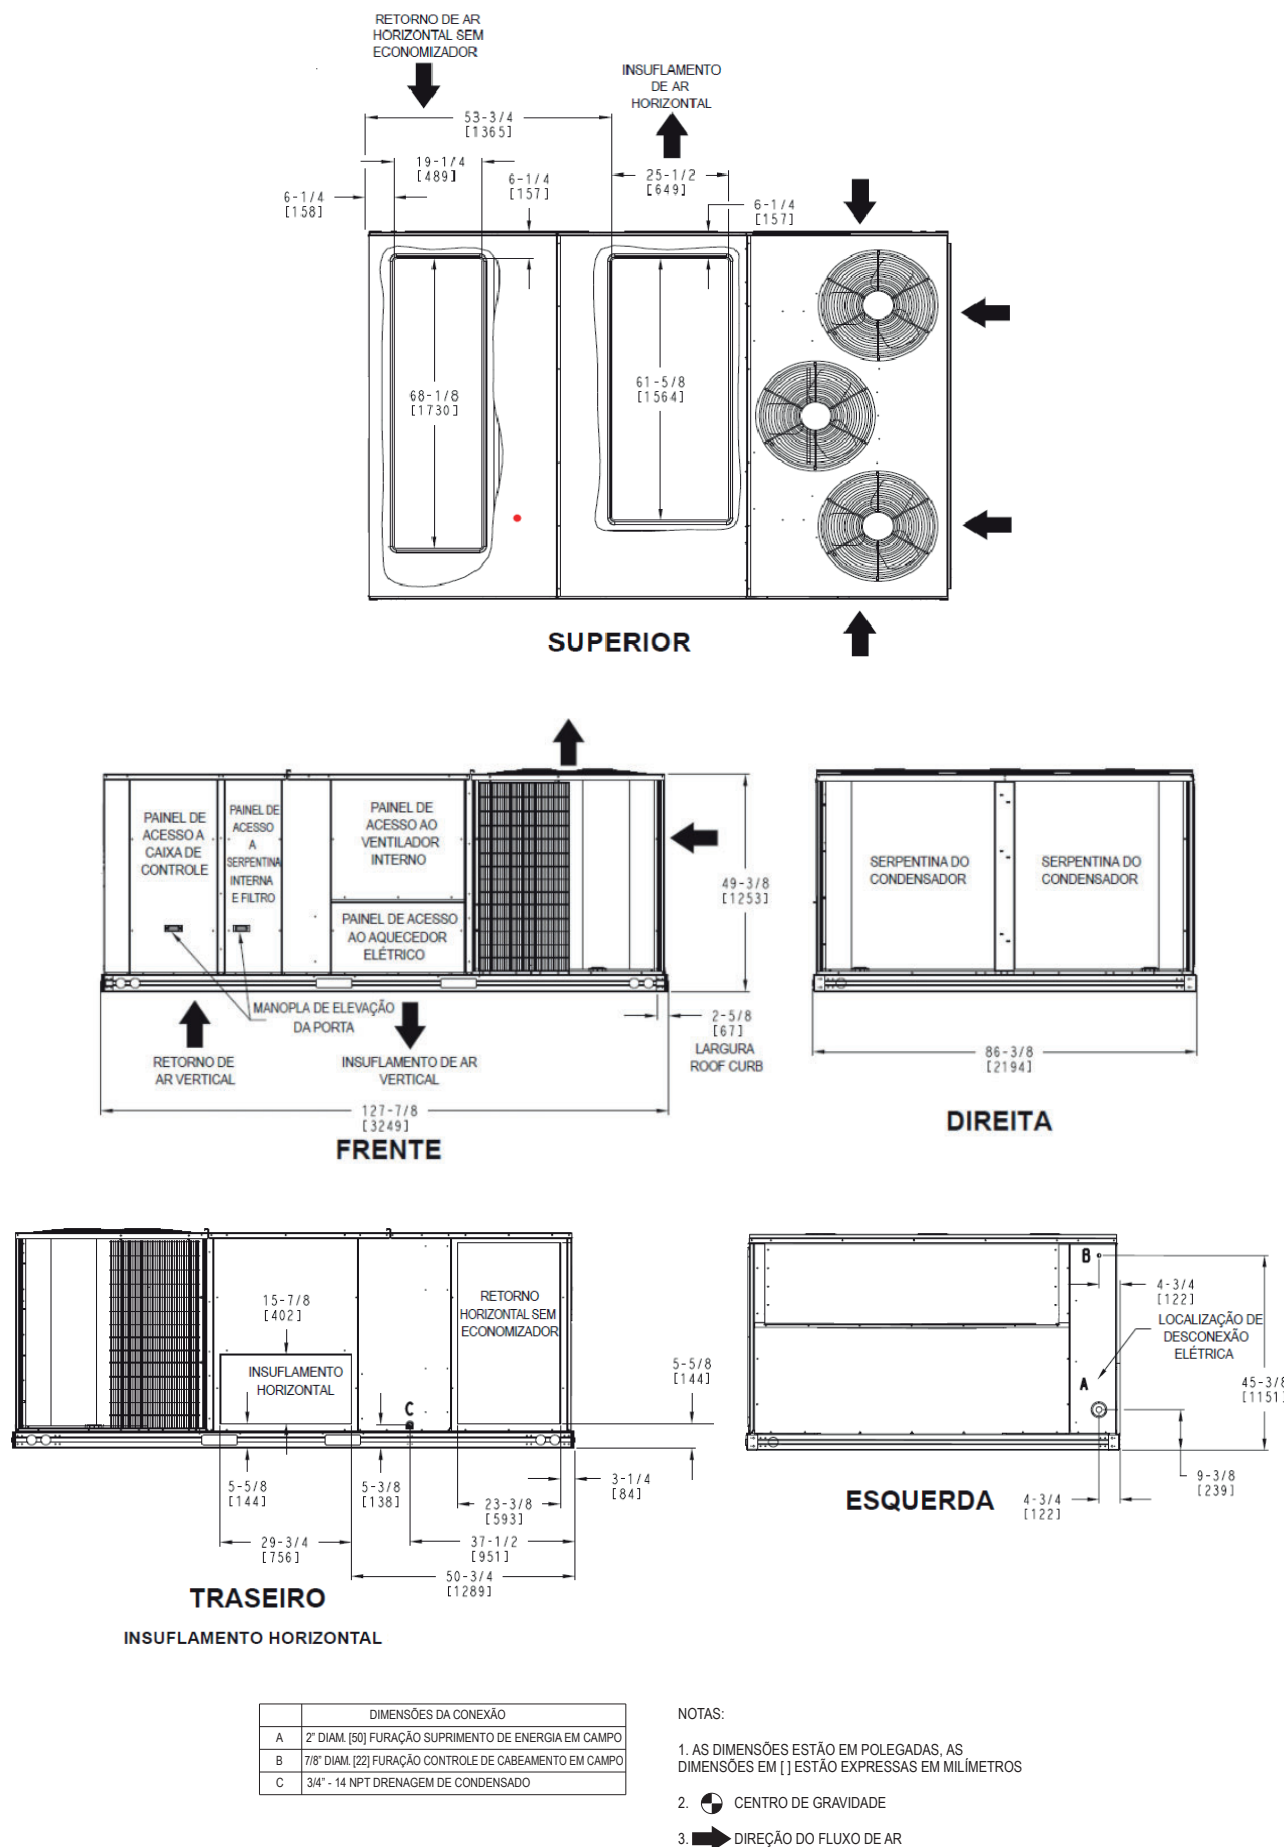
Desenho dimensional da unidade - 50TC_20
